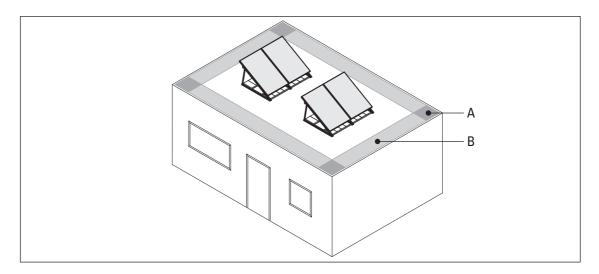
Distanze minime rispetto alle aree degli angoli e dei margini
